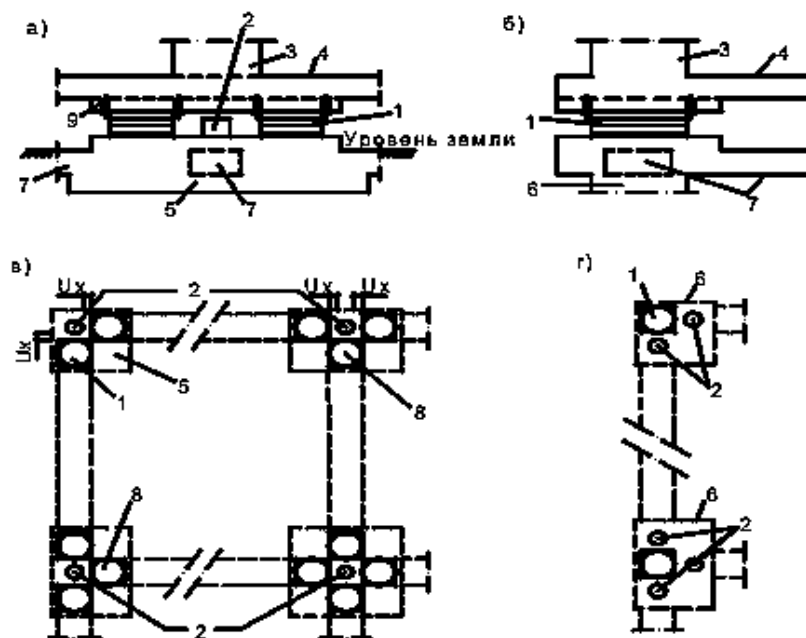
Схема размещения сейсмоизолирующих многослойных резинометаллических опор (Франция): а – на фундаментной плите; б – на капители колонн подземной части здания; в, г – варианты возможного расположения в плане сейсмоизолирующих опор и ограничителей перемещения: 1 – сейсмоизолирующая резинометаллическая опора; 2 – ограничитель; 3 – колонна первого этажа здания; 4 – плита перекрытия первого этажа; 5 – фундаментная плита; 6 – колонна подземной части здания с капителью; 7 – фундаментная балка; 8 – третья возможная опора; 9 – анкерный болт.
